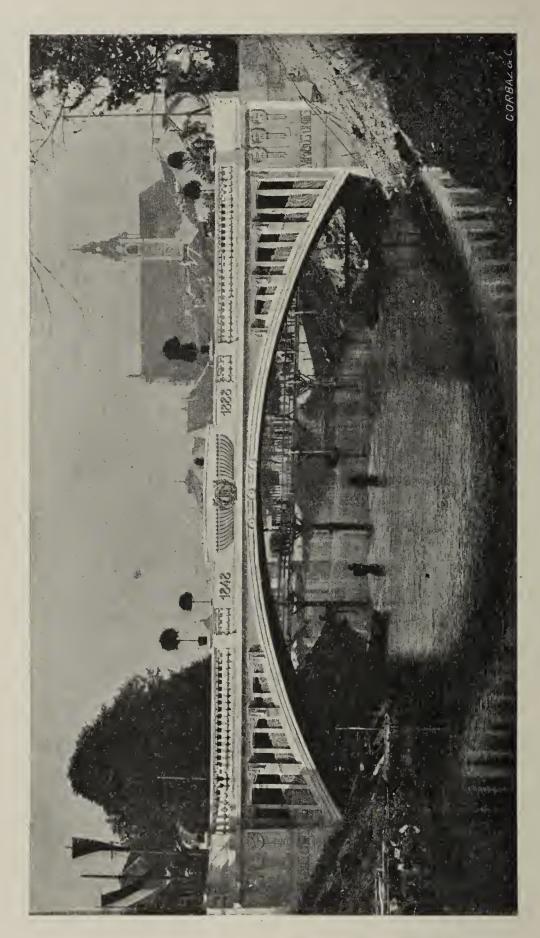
Kaiser Franz Josef=Brücke in Laibach.
